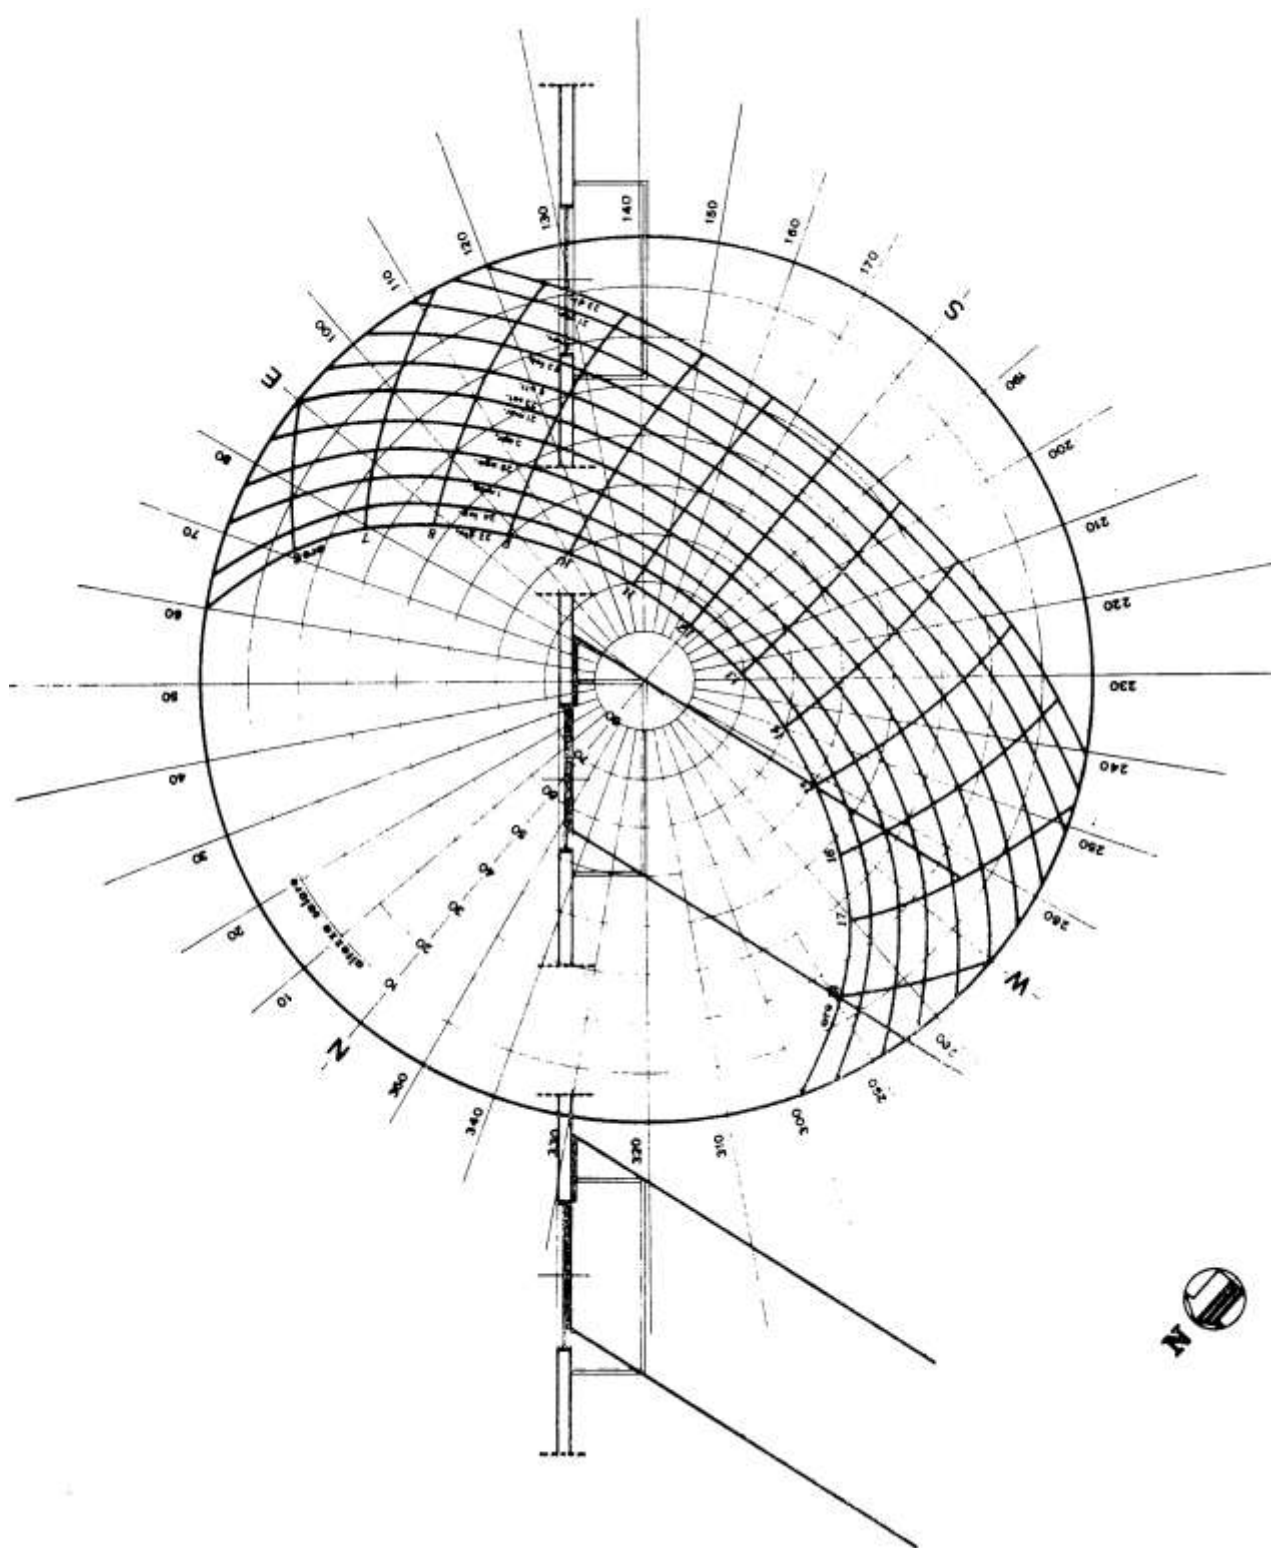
Determinazione della traccia dell'ombra proiettata dal balcone sul piano orizzontale
